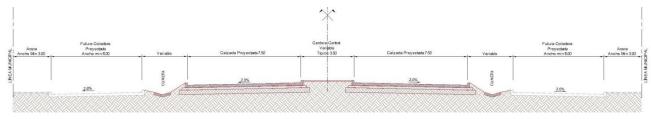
Perfil tipo de la avenida con cunetas a ambos lados.
